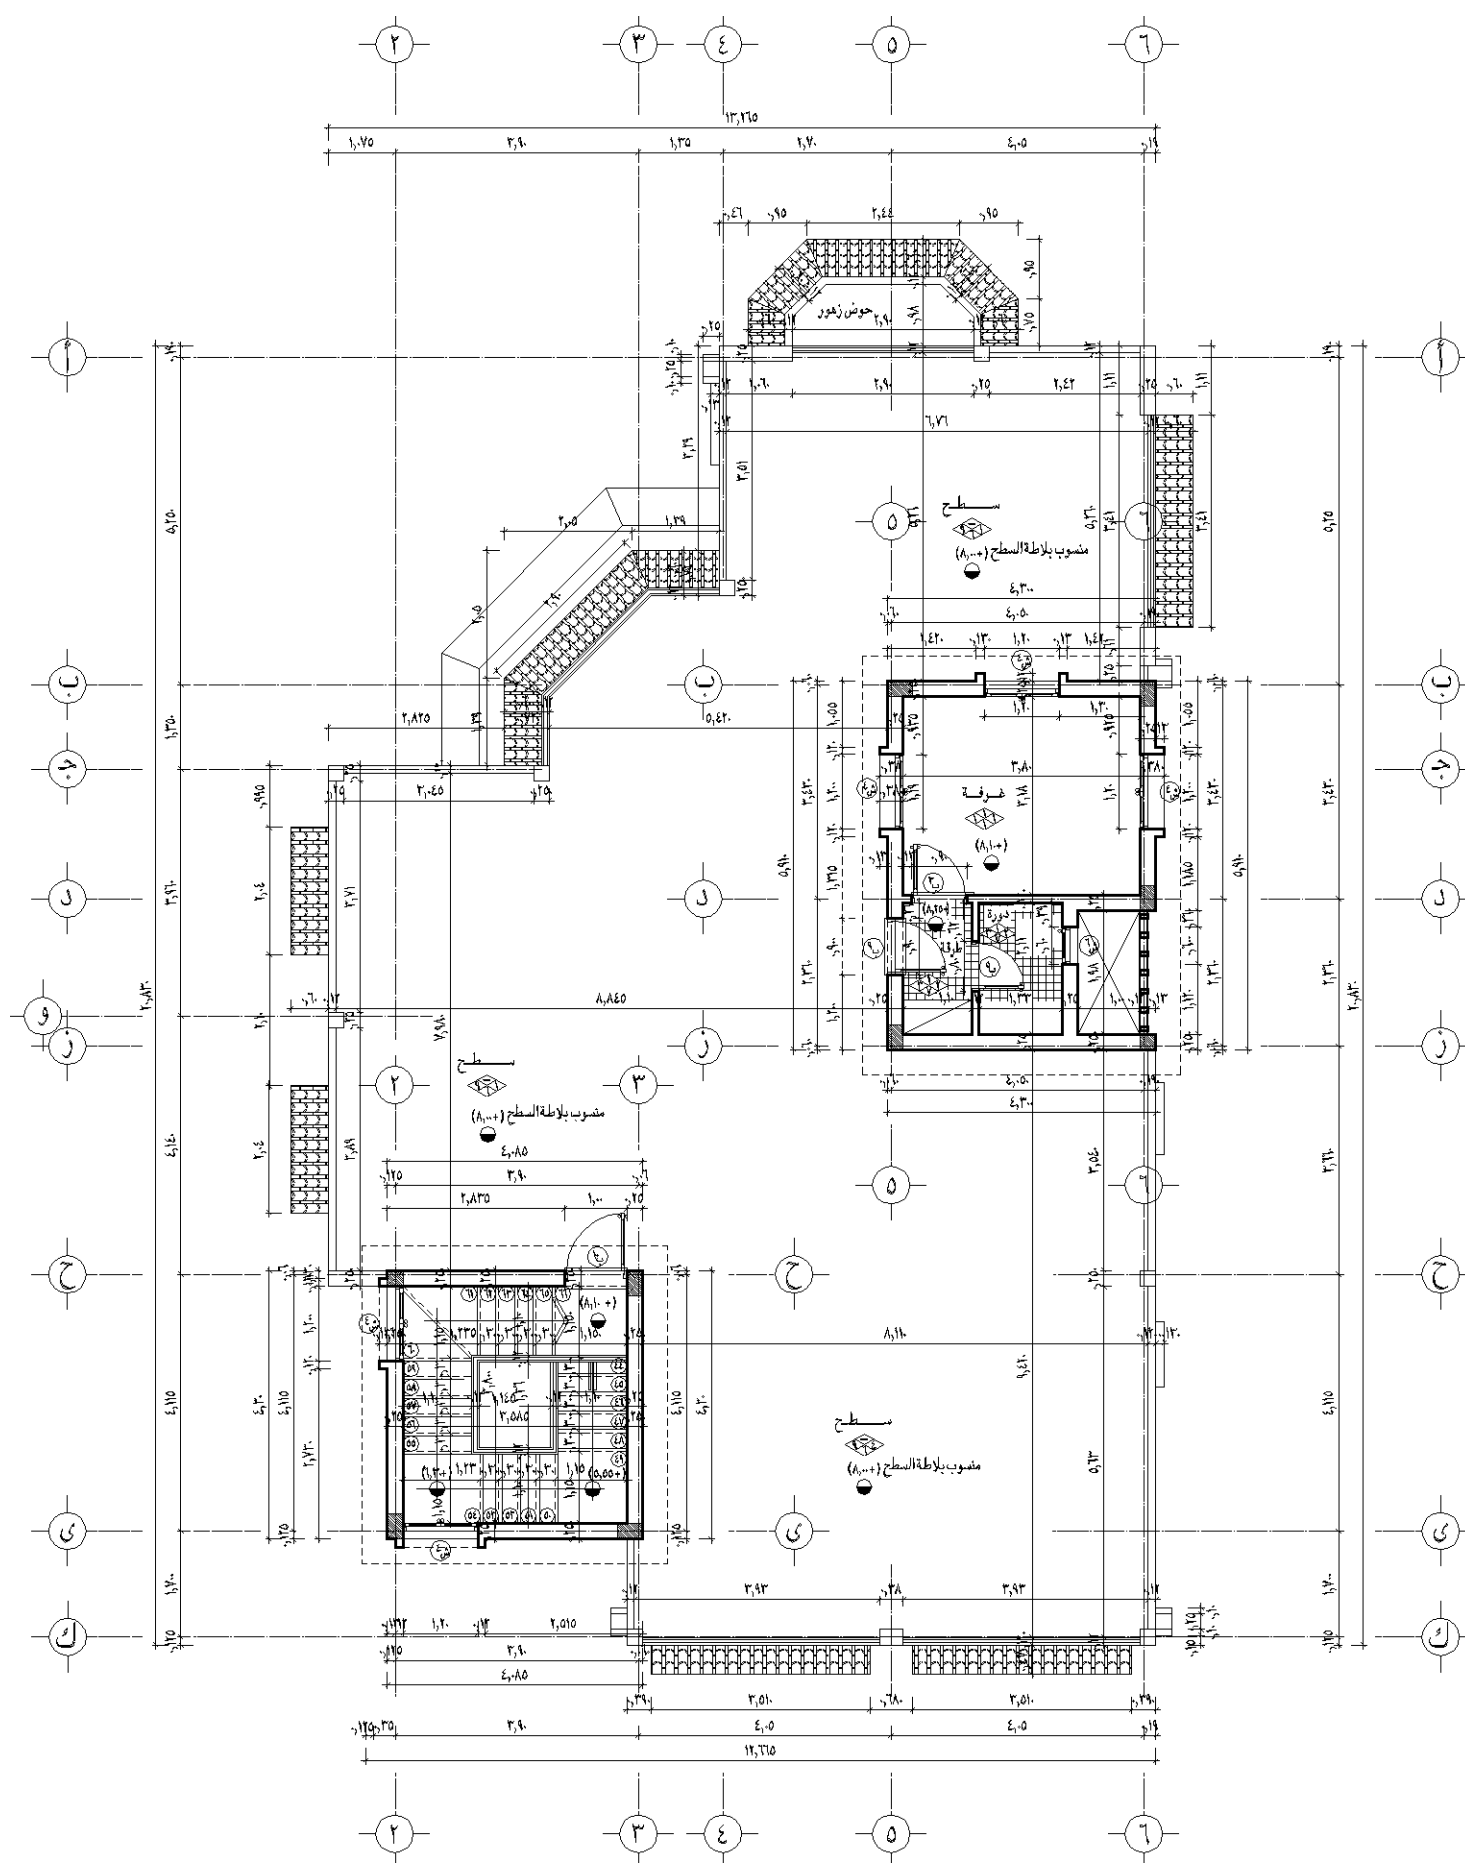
مثال على مسقط أفقى تنفيذى لدور أول علوى
